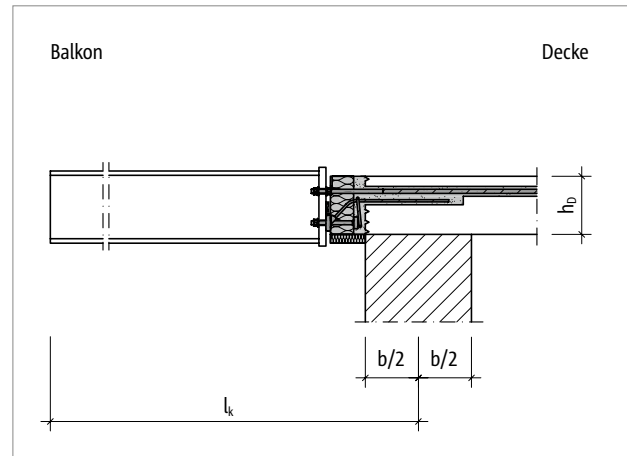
Schöck Isokorb® RT Typ SK: Statisches System
